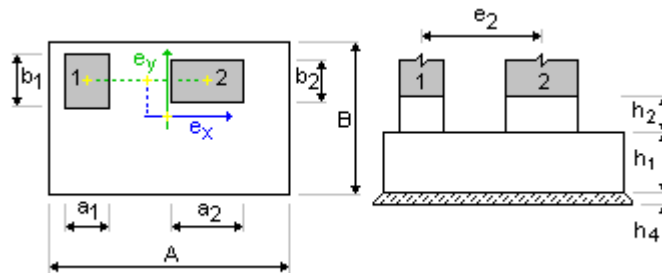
Dimensionnement d'une semelle filante e dans le sens x-x.
